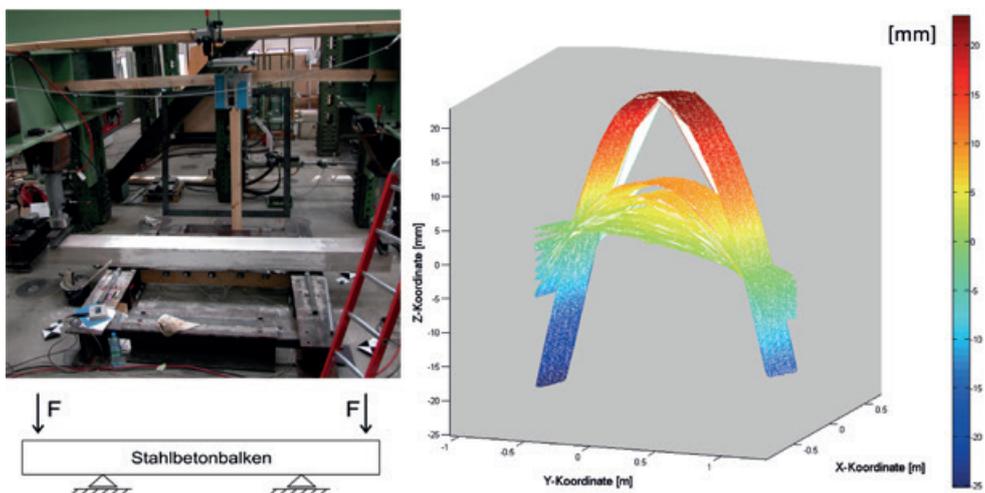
Biegebeanspruchung eines Stahlbetonbalkens mit oberhalb montiertem Laserscanner
